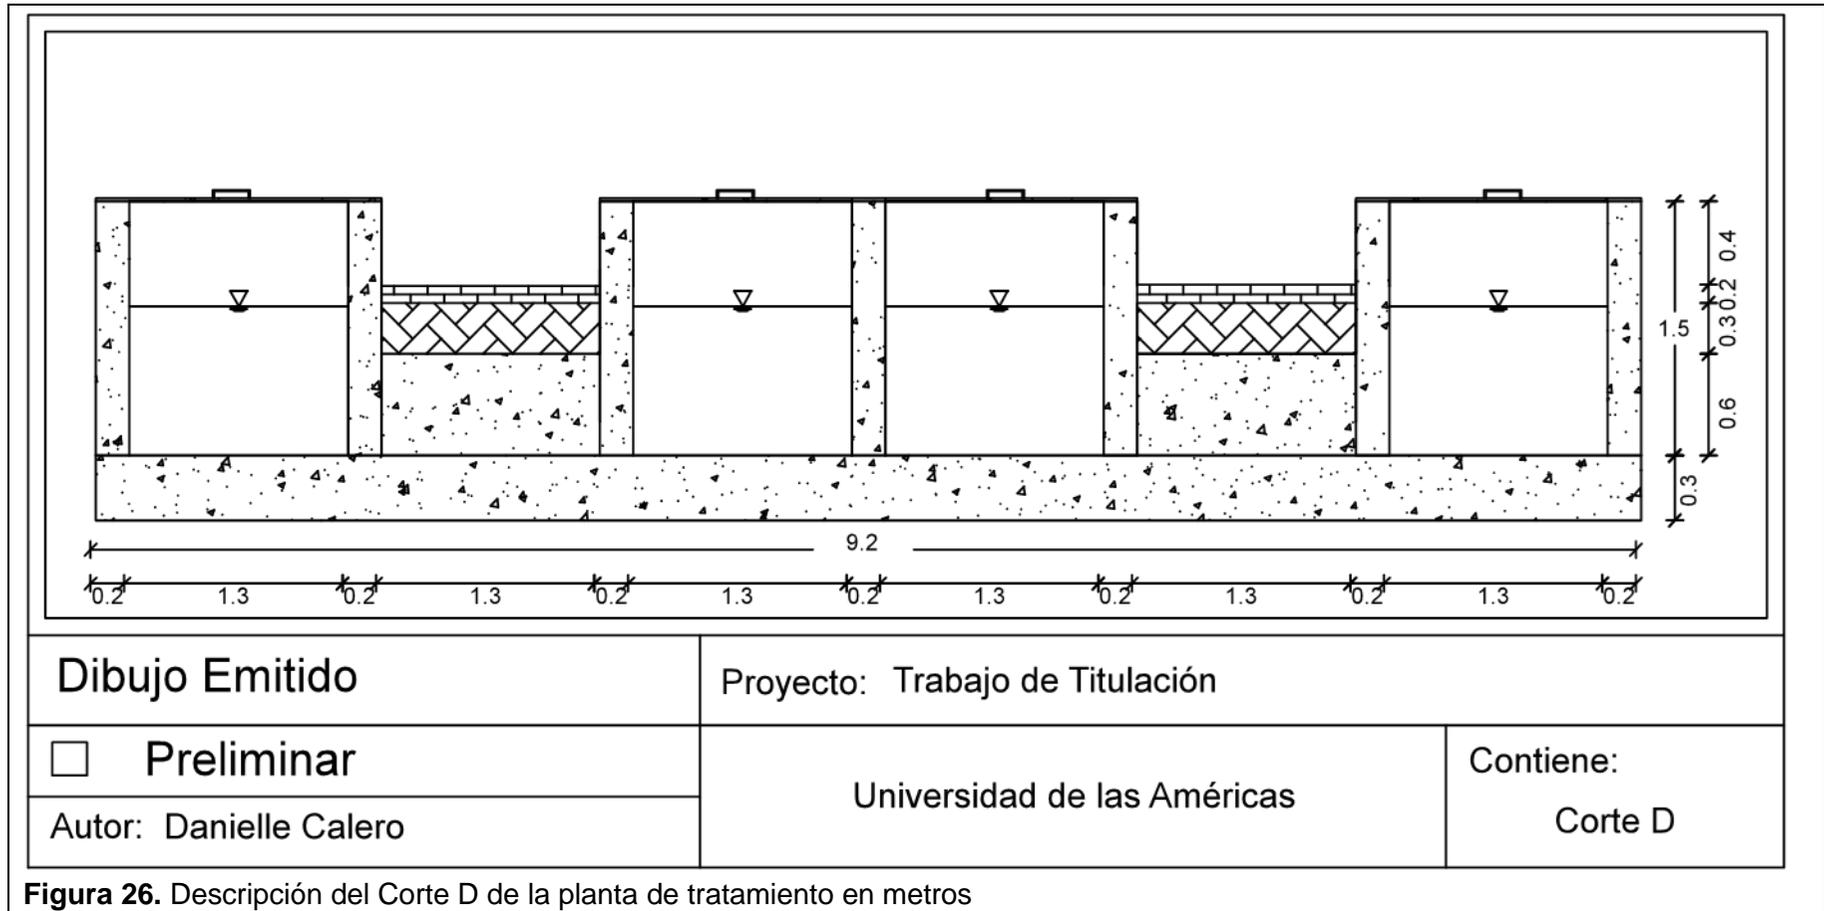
Descripción del Corte D de la planta de tratamiento en metros
